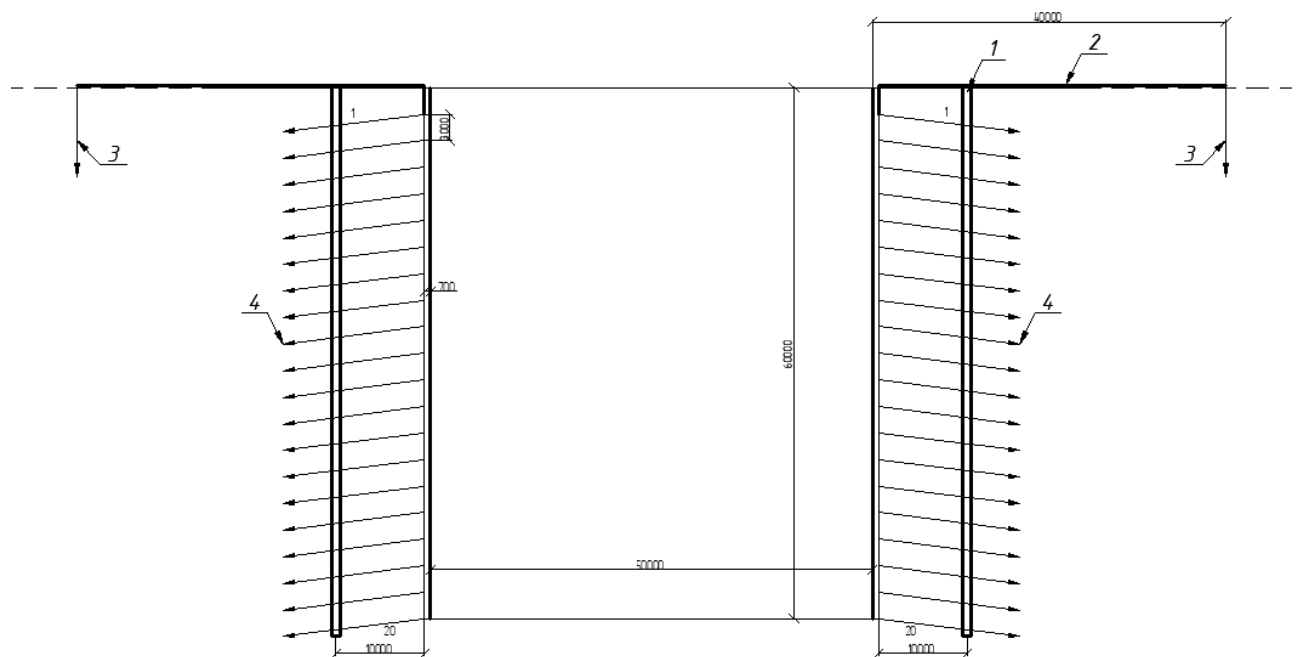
Разрез котлована с дополнительными элементами крепления стенок
